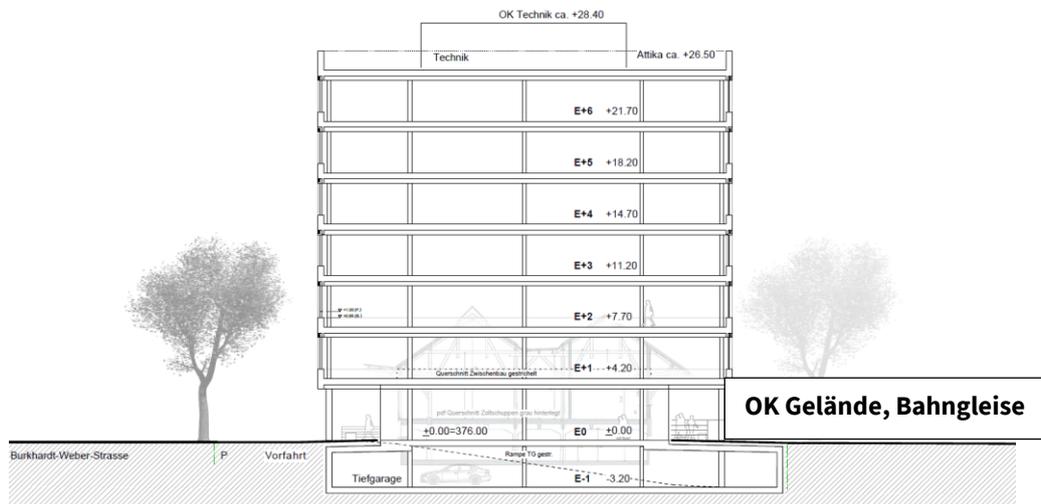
Schnitt nach der Planstand 11.01.2021 (parallel zur Bahnlinie);
